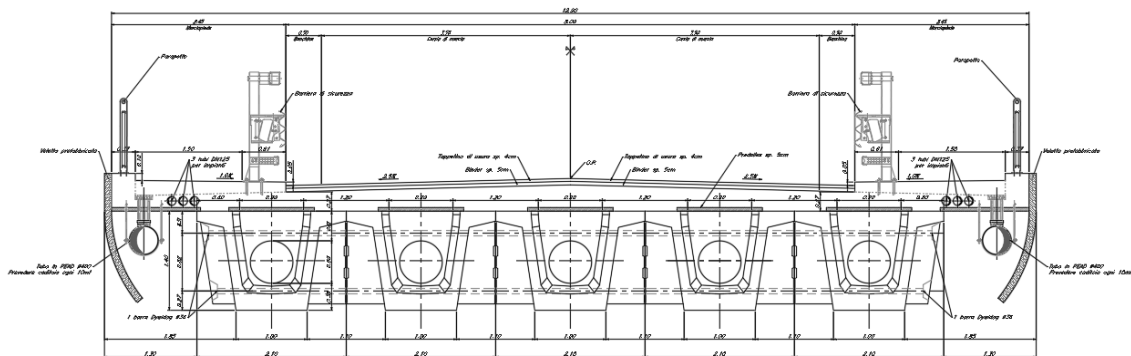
Ponte Frestola: Sezione trasversale impalcato
